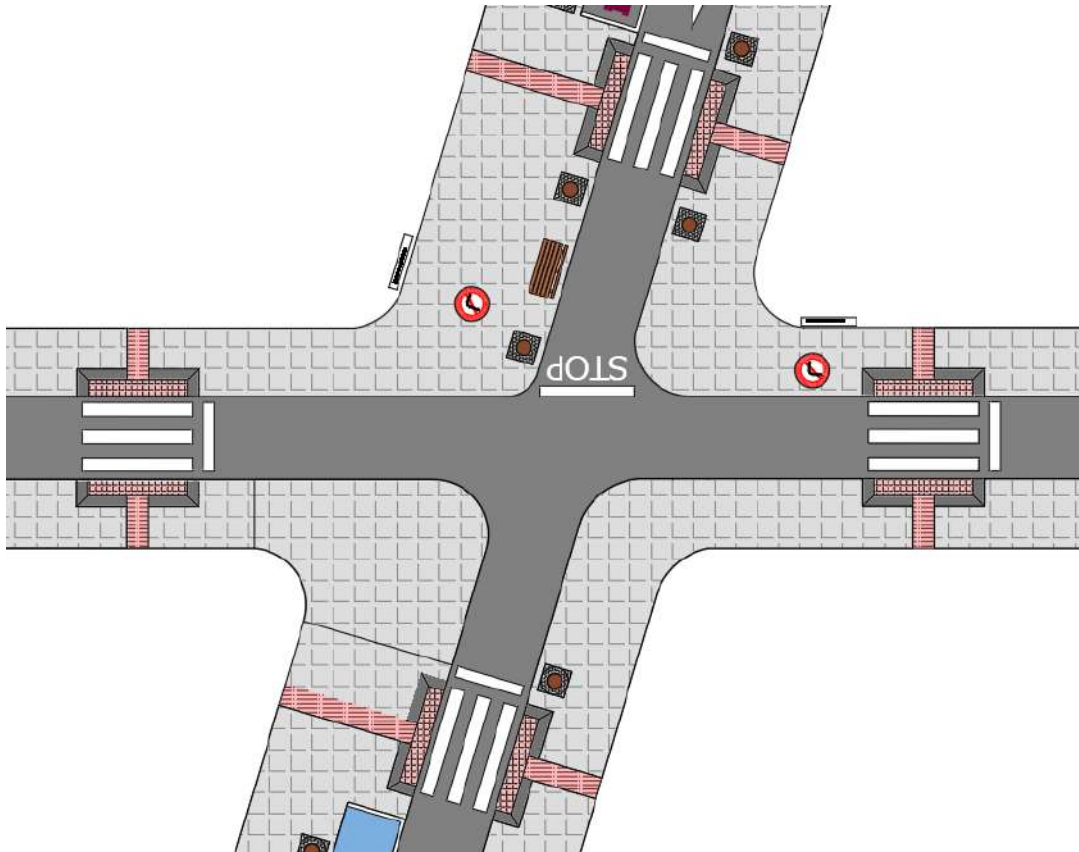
Diseño de la intersección. Fuente: Autocad.
